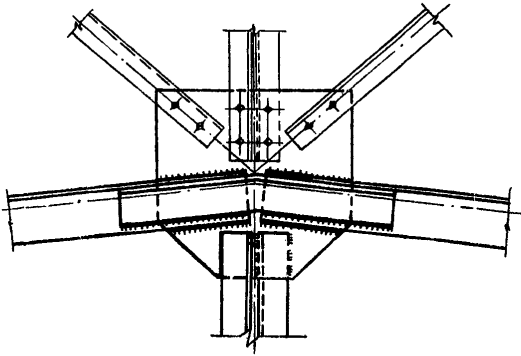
Крепление фонаря в коньковом узле фермы с помощью выпущенной кверху фасонки
